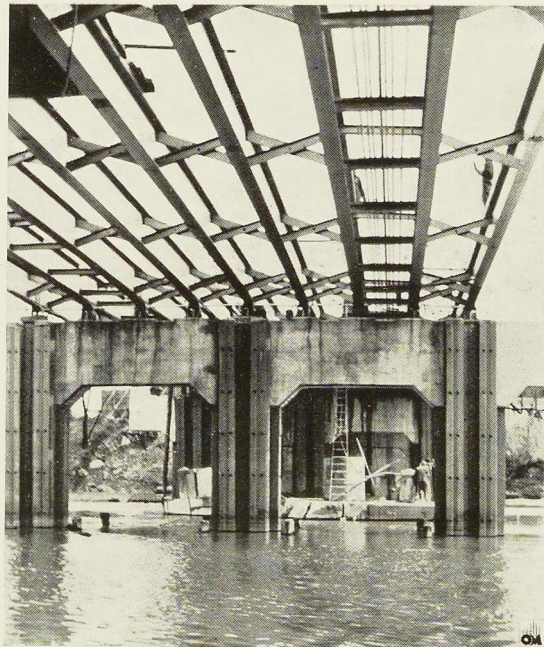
Elévation d'un pont-route reposant sur des piles en palplanches métalliques.
